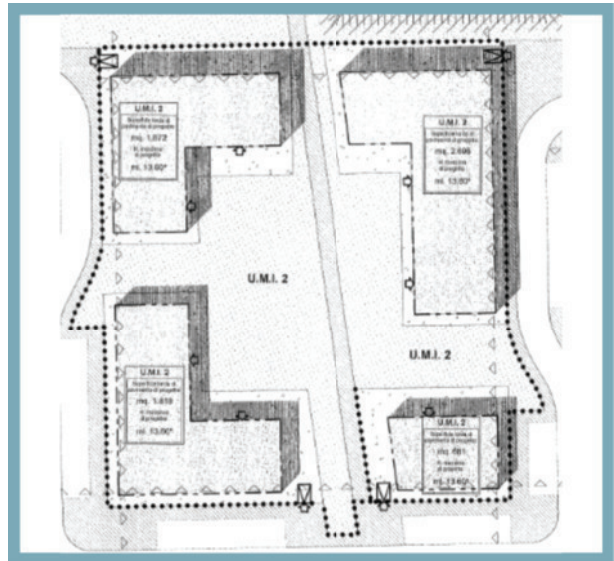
Estratto della Tav. 06 allegata al PP approvato con DGC n. 32/2010
